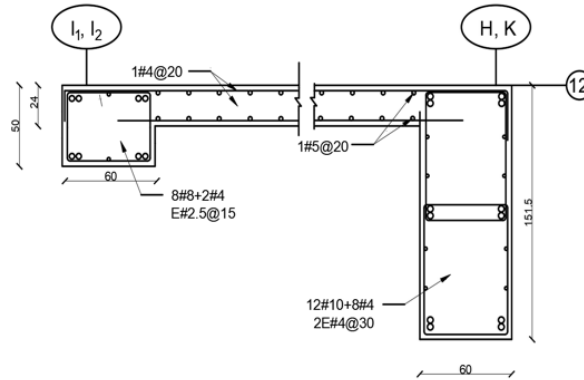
Ejemplo de sección transversal de muros E por nivel de fachada Oeste (adaptado de SRE, 1963).
